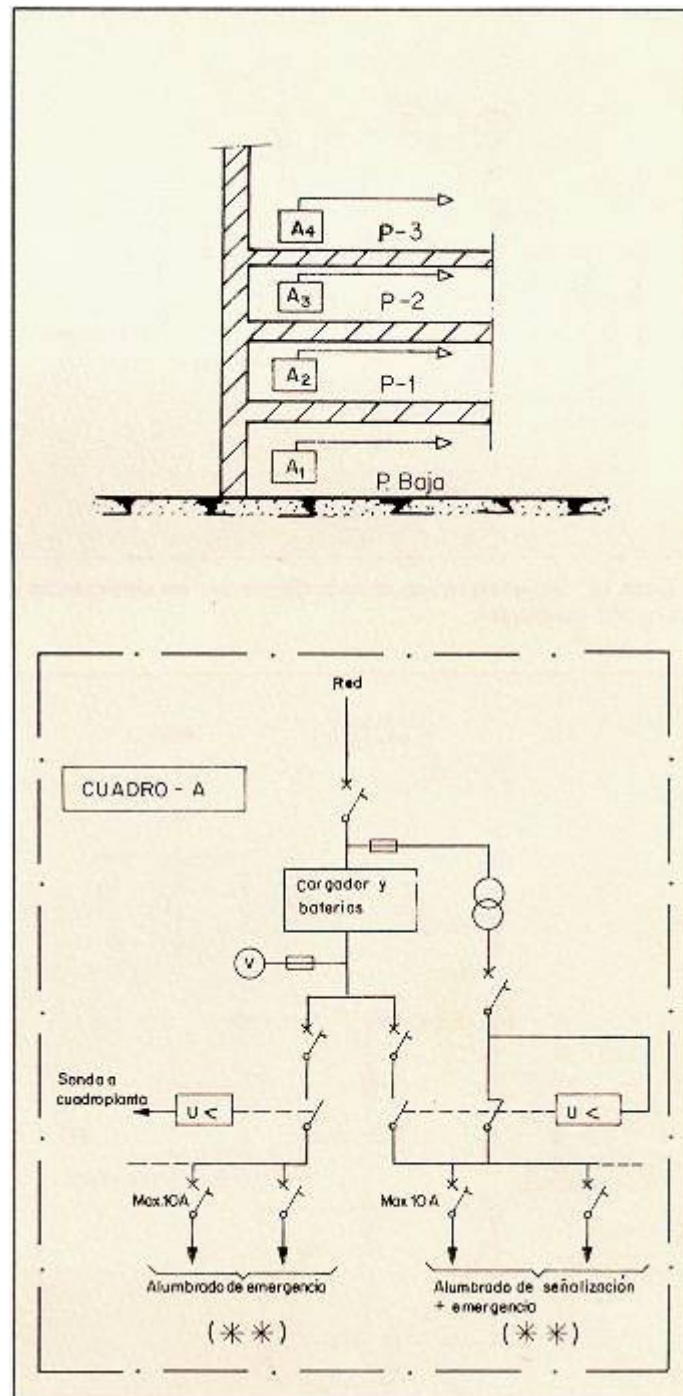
Sistema centralizado con baterías. Alumbrados de emergencia y señalización más emergencia. Un equipo por planta
